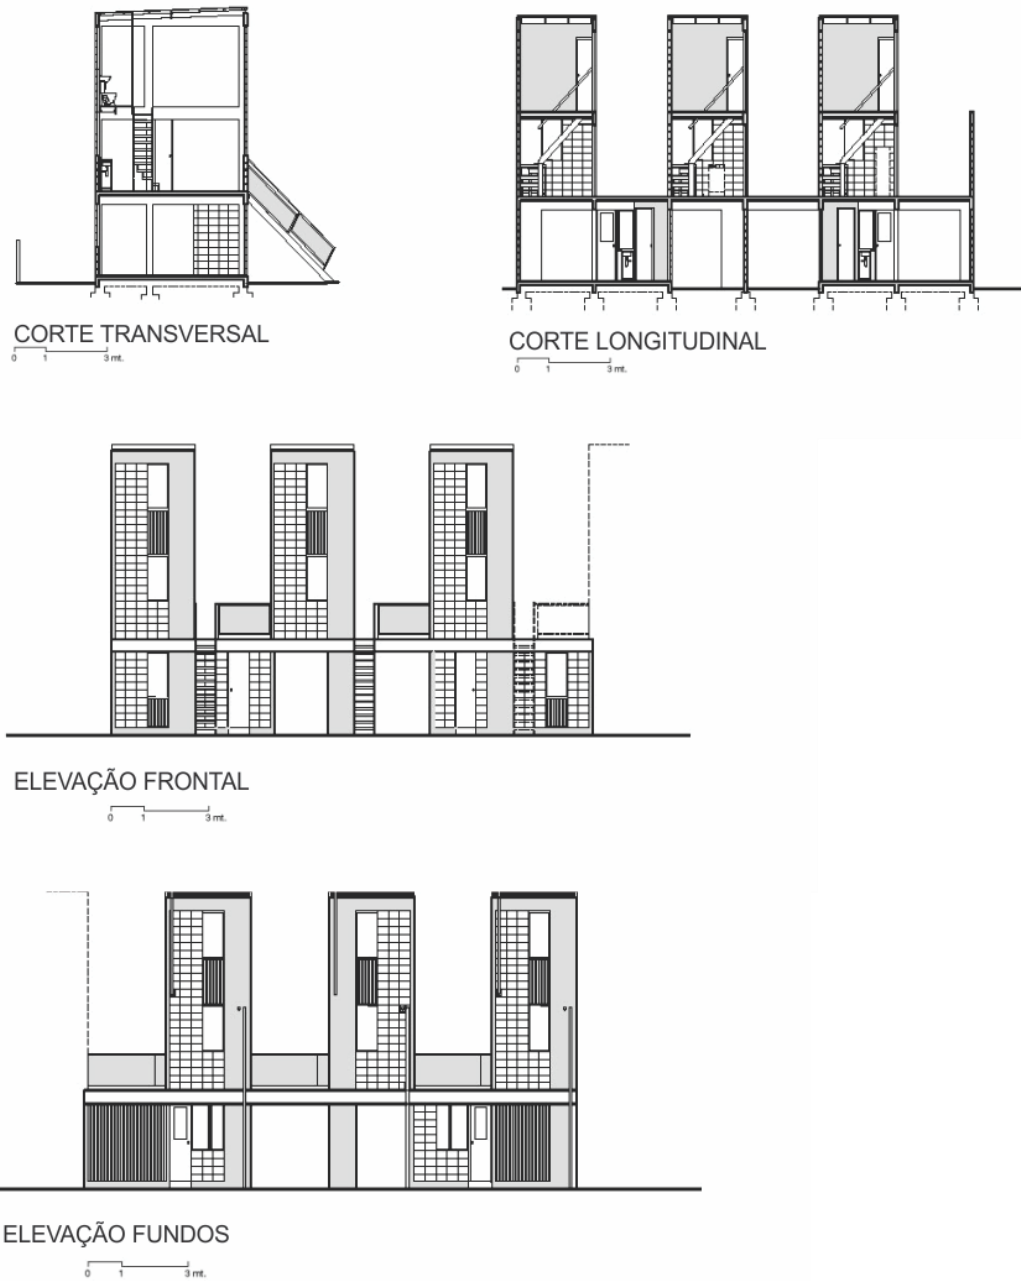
CORTES E ELEVAÇÕES – QUINTA MONROY
